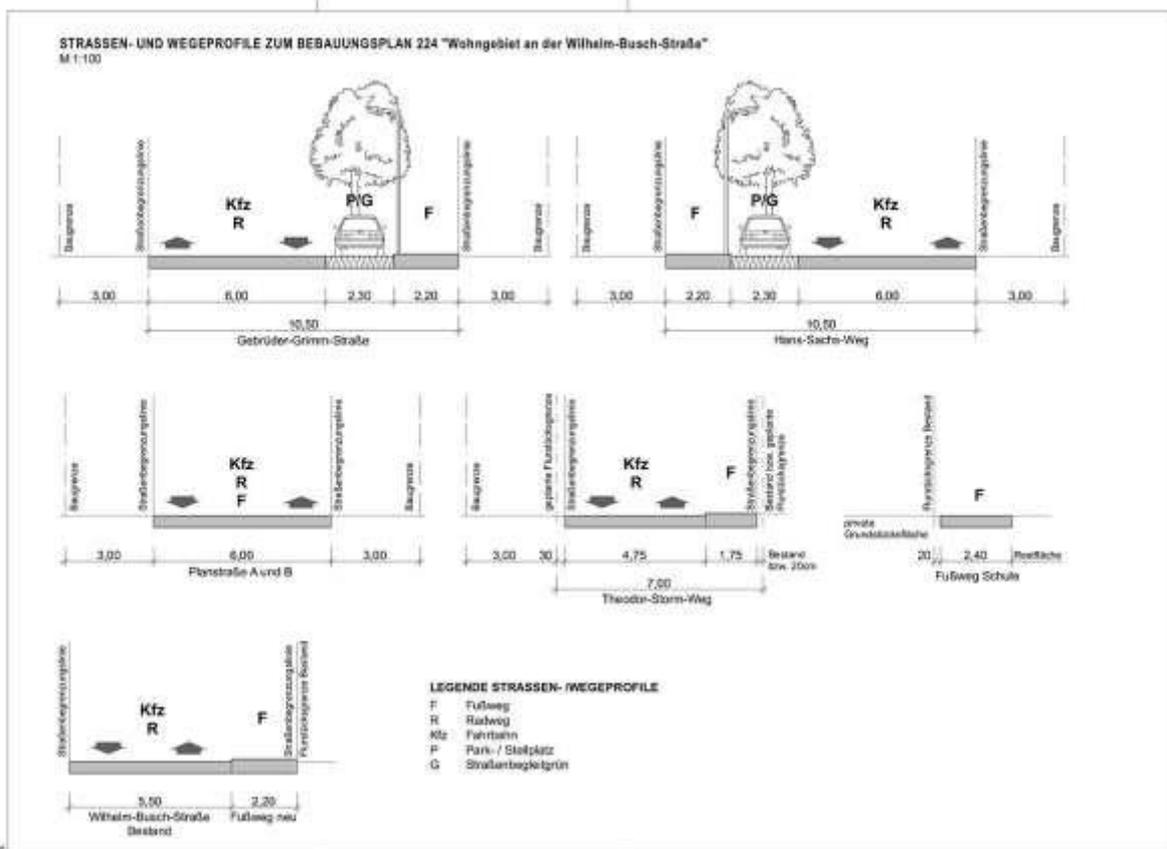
Straßen und Wegeprofile zum Bebauungsplan Nr. 224
